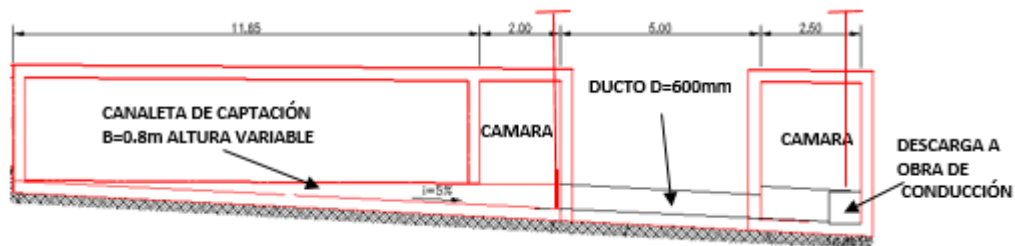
PLANTA OBRA DE TOMA.
